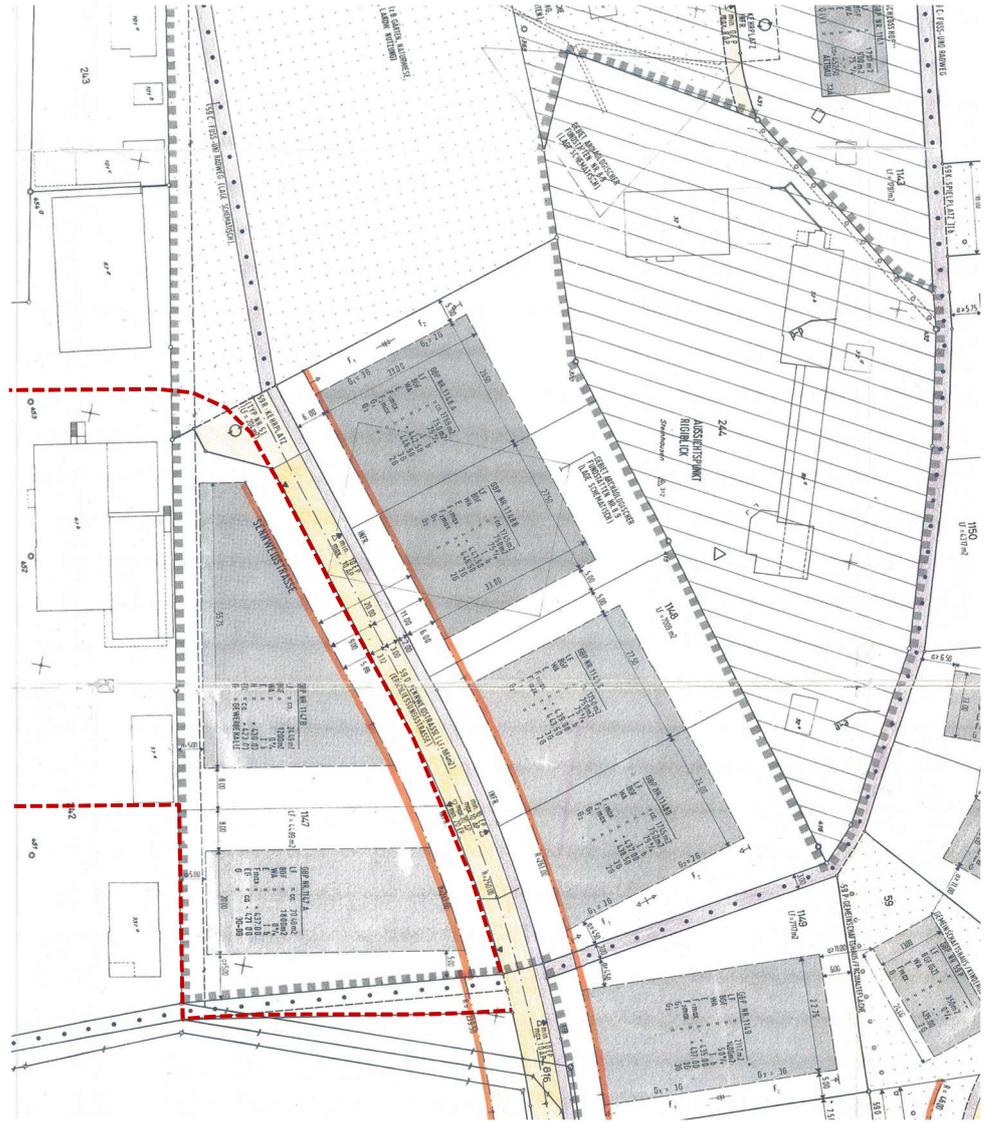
Ausschnitt aus dem Baulinien- und Bebauungsplan «Schlossberg» (nach Norden ausgerichtet), Studienauftragsperimeter rot markiert
